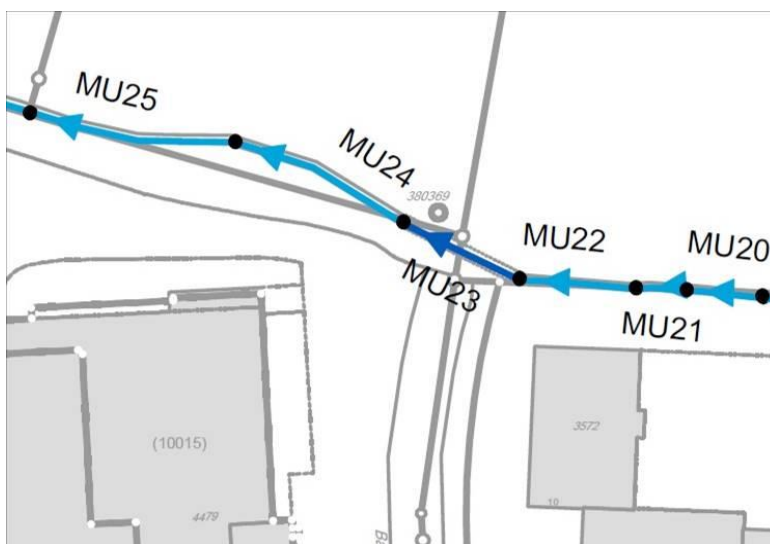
; Ausschnitt aus Plan Haltungen GEP (Genereller Entwässerungsplan) Berechnung (ohne Massstab)
